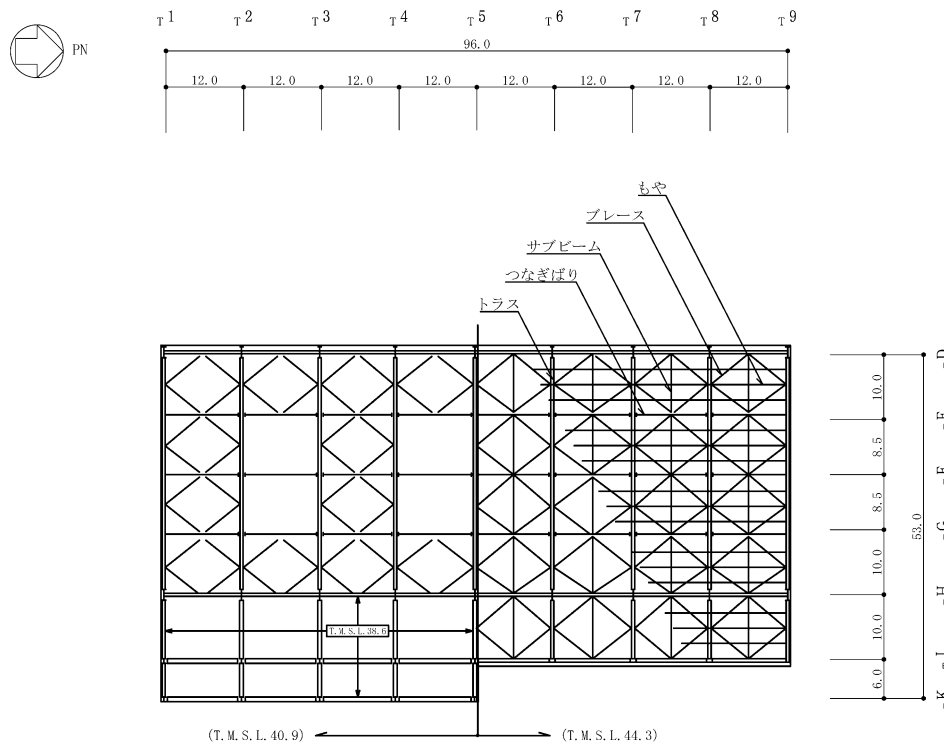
タービン建屋の概略平面図 (RF, T.M.S.L. 44.3m) (6/6) (単位 : m)
